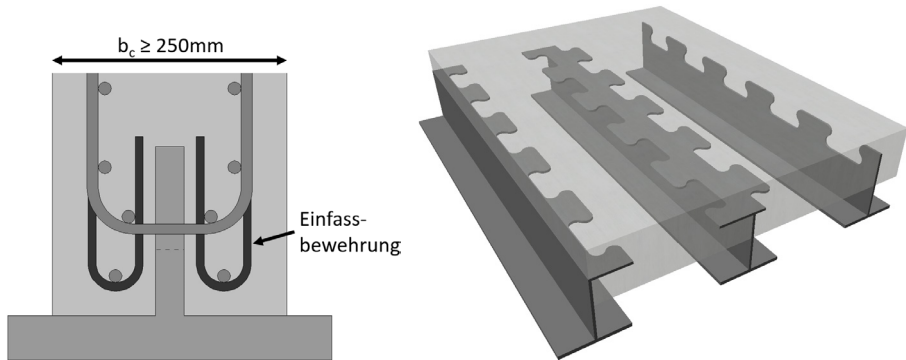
Einfassbewehrung und Mindestbetonplattendicke bei parallel zur Betonplatte verbauter Verbunddübeln gemäß [DIBt 2016] (links) sowie mögliche Einbaupositionen oberflächennaher Verbunddübeln (rechts)
